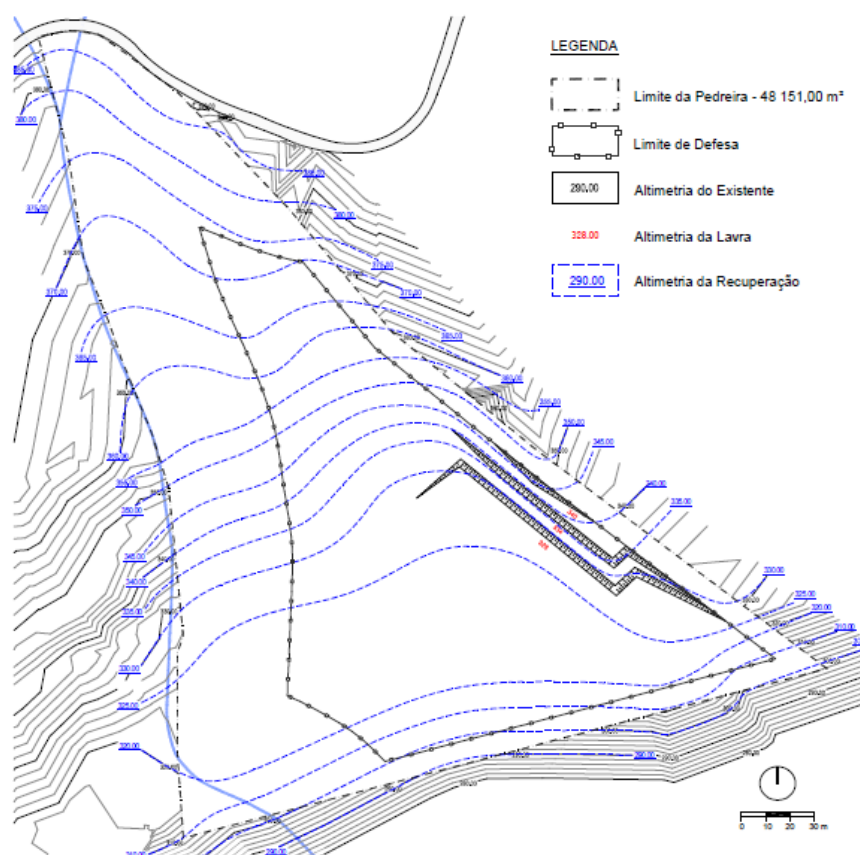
Plano de Modelação do Terreno (PARP, 2013).
